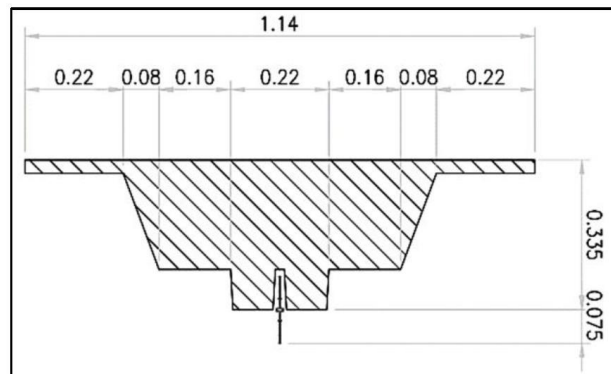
Sección transversal de junta trapezoidal de 1140mm.
